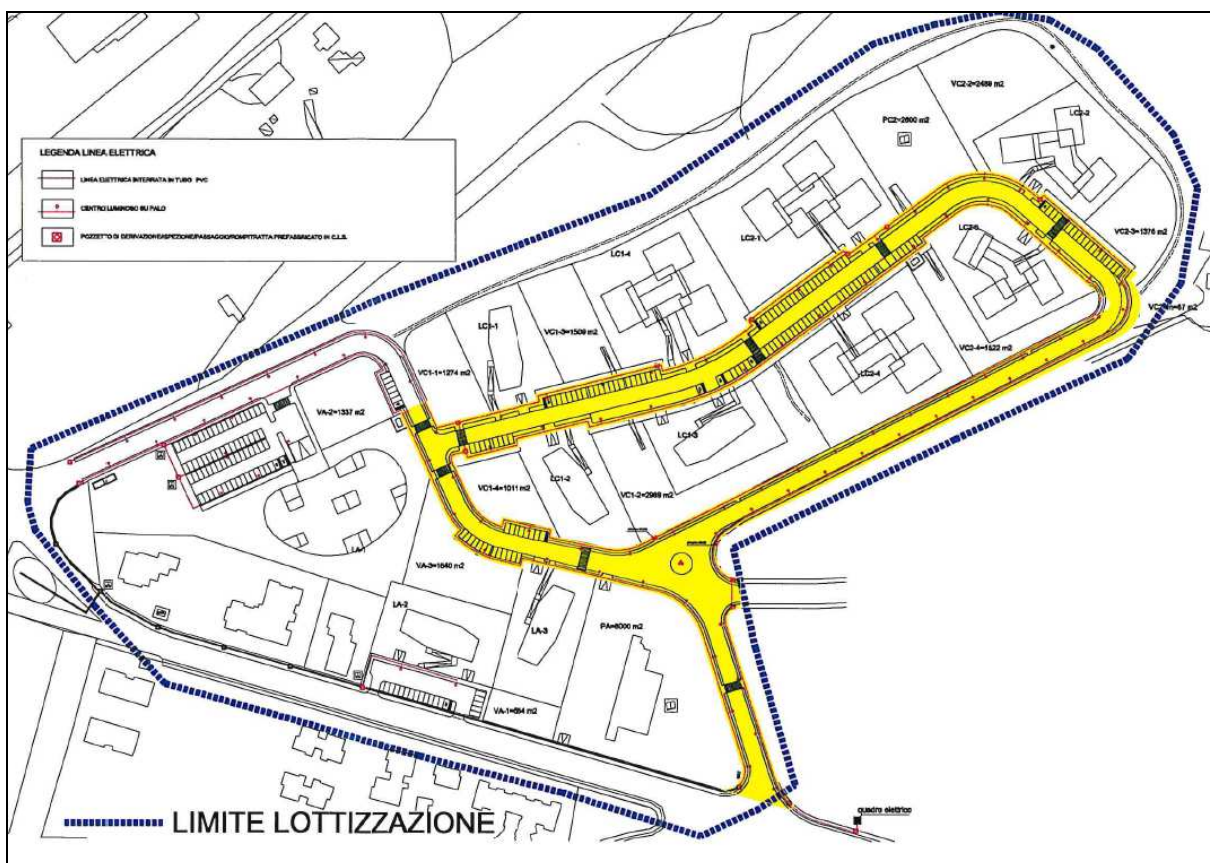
Estratto dalla “planimetria rete pubblica illuminazione” allegata al collaudo – 2° stralcio con evidenziate le parti collaudate
